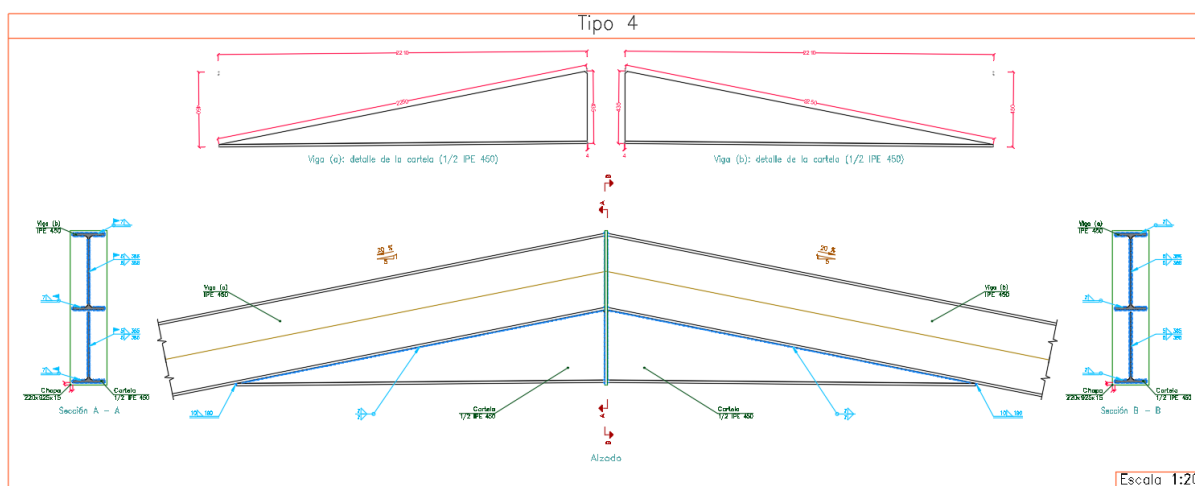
Detalle de unión soldada jácena-jácena en cumbrera
